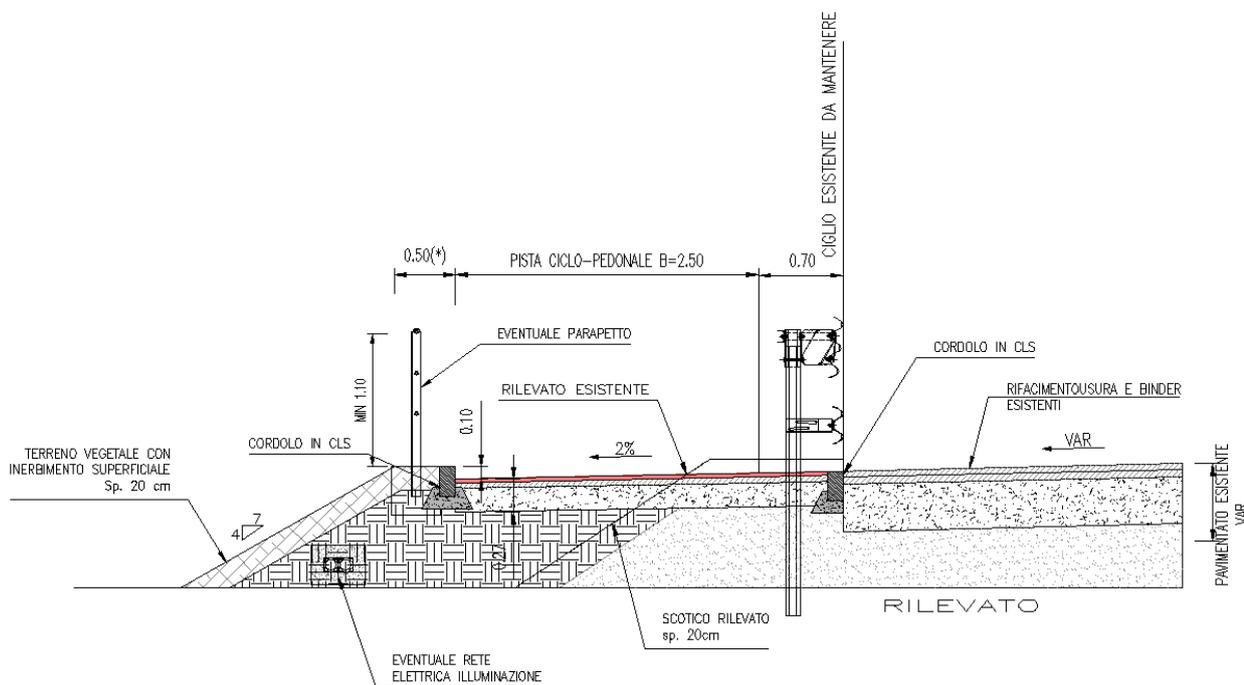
Sezione tipo di progetto pista ciclabile in affiancamento alla SP204
